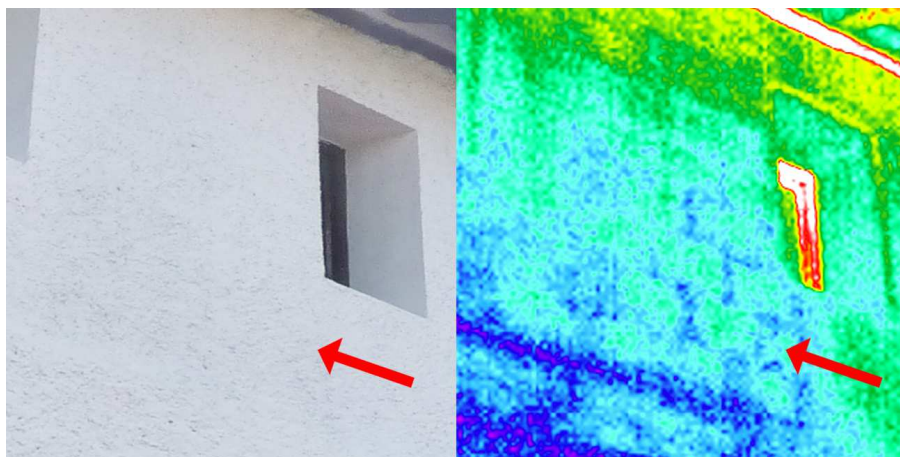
Sillares ocultos en el segundo piso de la fachada posterior
